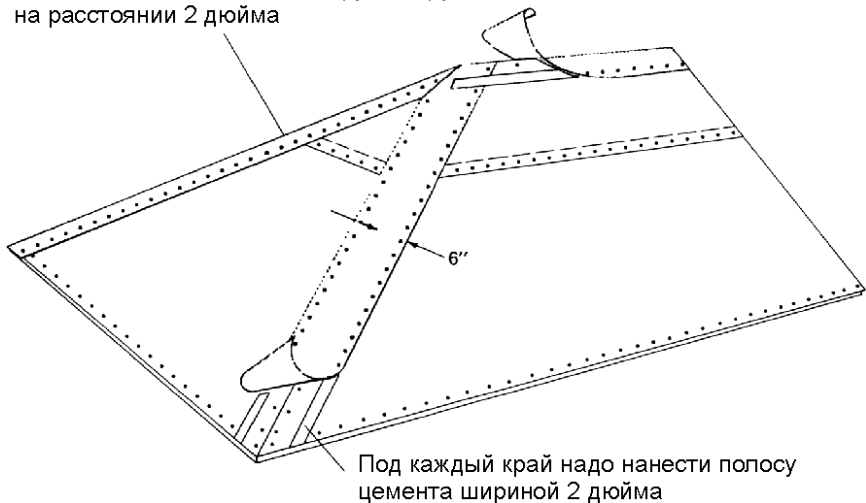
Укладка рулонных кровельных материалов с использованием метода открытых гвоздей (параллельно фронтонным свесам) (Bird and Son)
